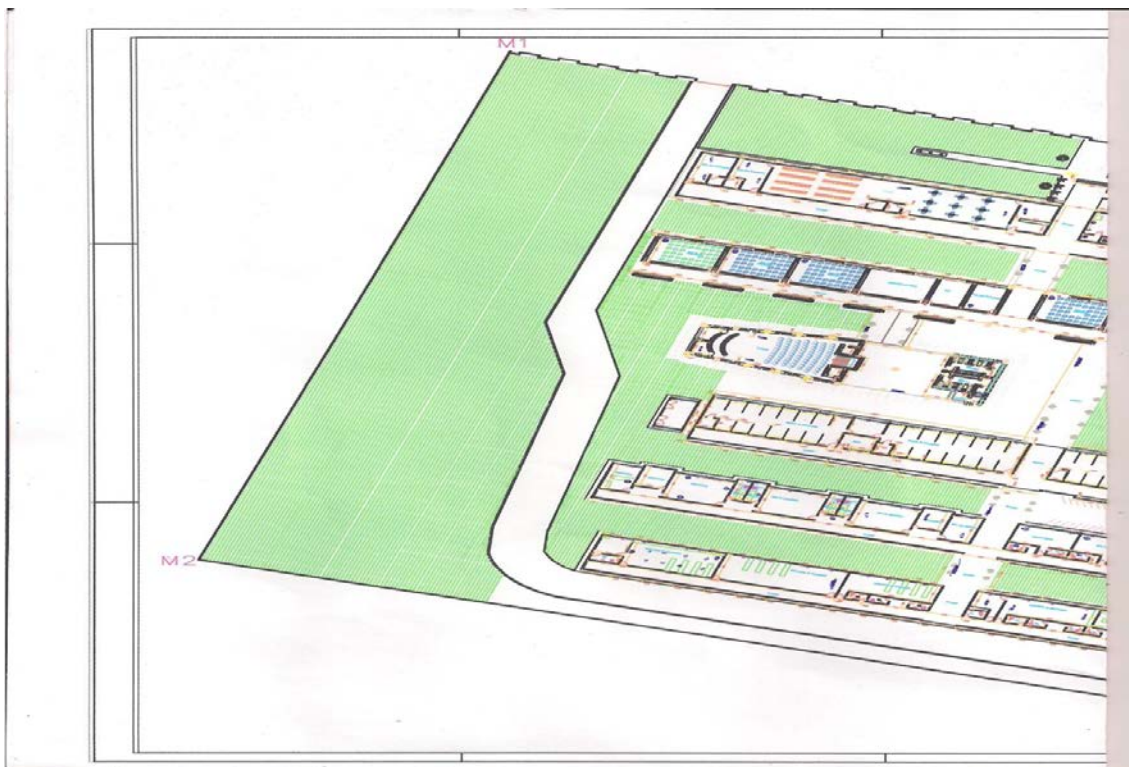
Parte 1 da planta baixa do *Campus VIII*, da UEPB.
